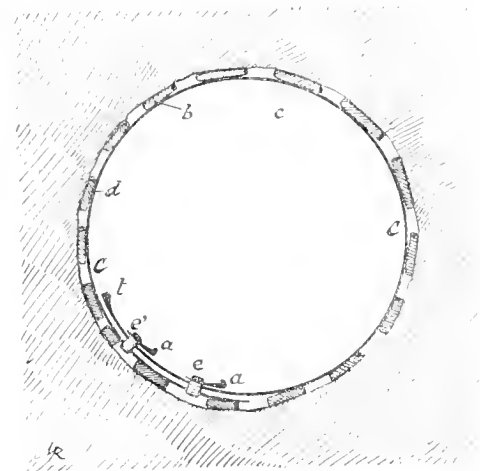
Coupe horizontale du coffrage d'un puits circulaire.
